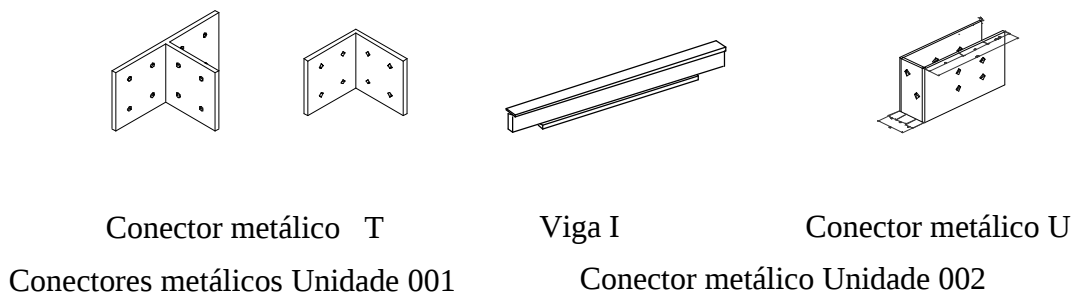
Chapas metálicas utilizadas na ligação da viga com o pilar
